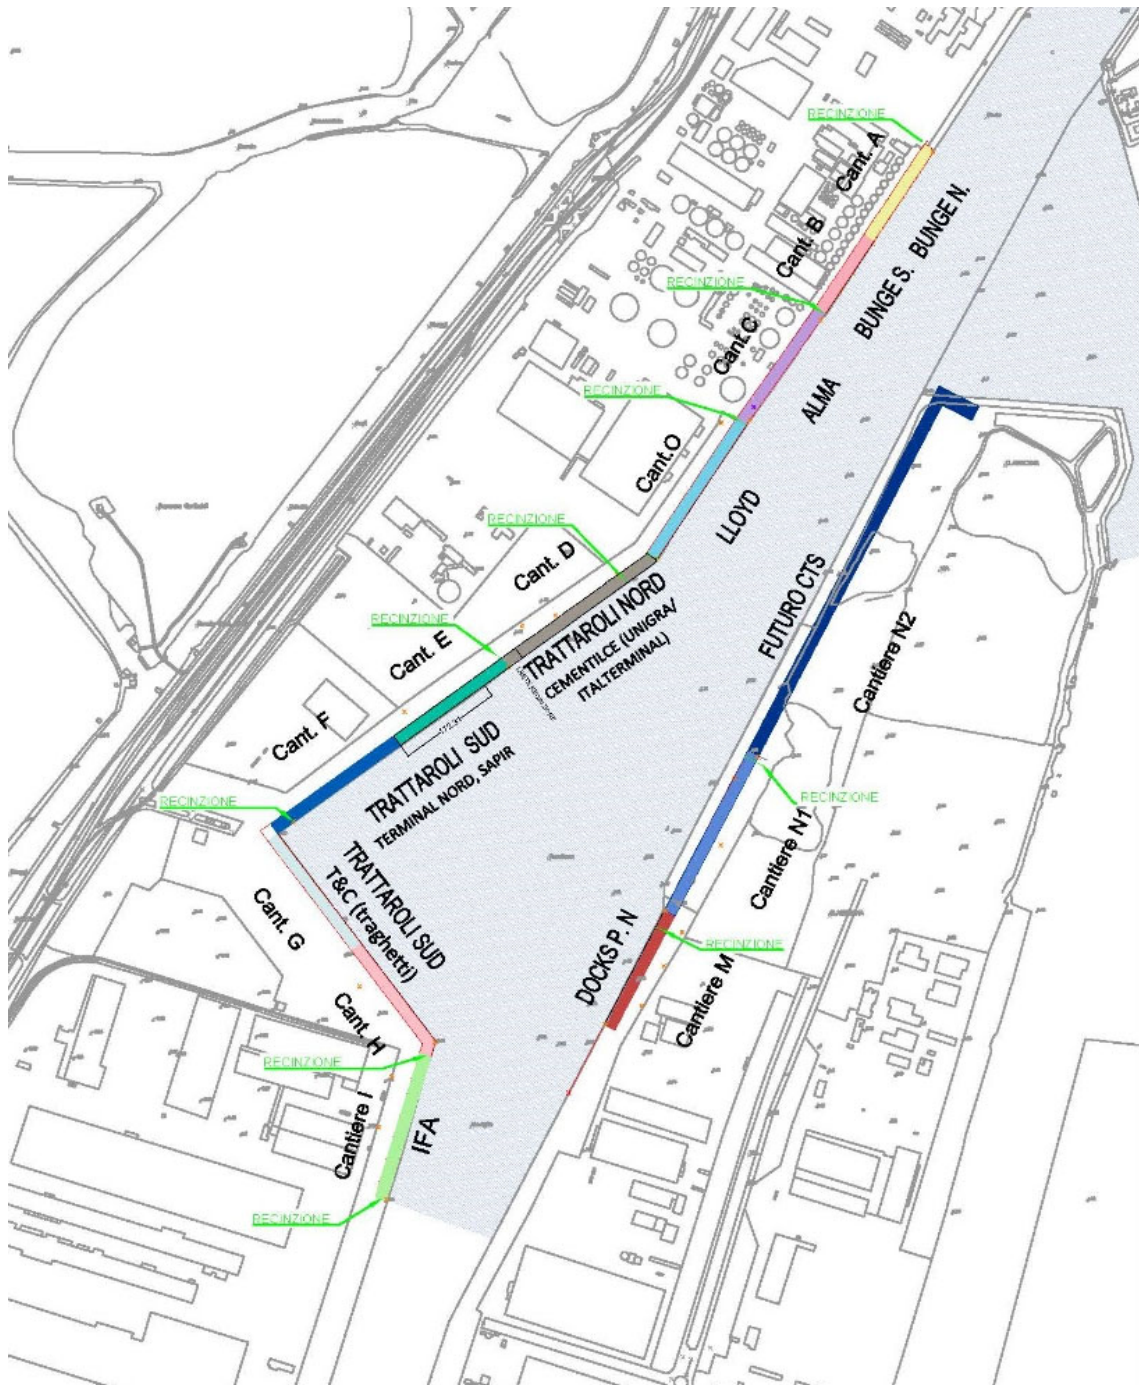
Planimetria di inquadramento con ubicazione delle banchine e relativi cantieri
